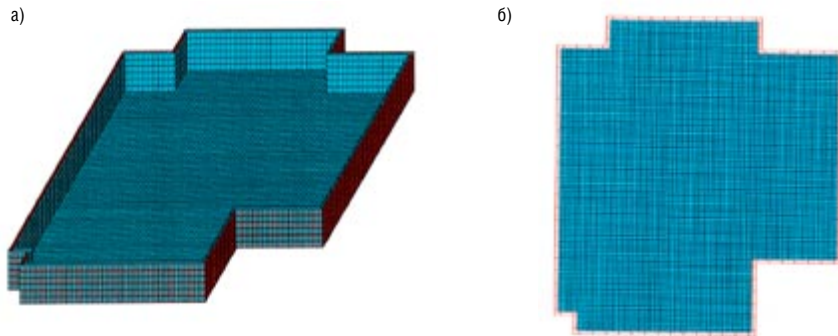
Расчетные схемы фрагментов здания, образованные монолитным диском перекрытия с опирающимся на него внутренним слоем. Лицевой слой опирается на стальной уголок или железобетонную балку, соединенную с плитой железобетонными ребрами. Соединение слоев осуществлено гибкими связями
